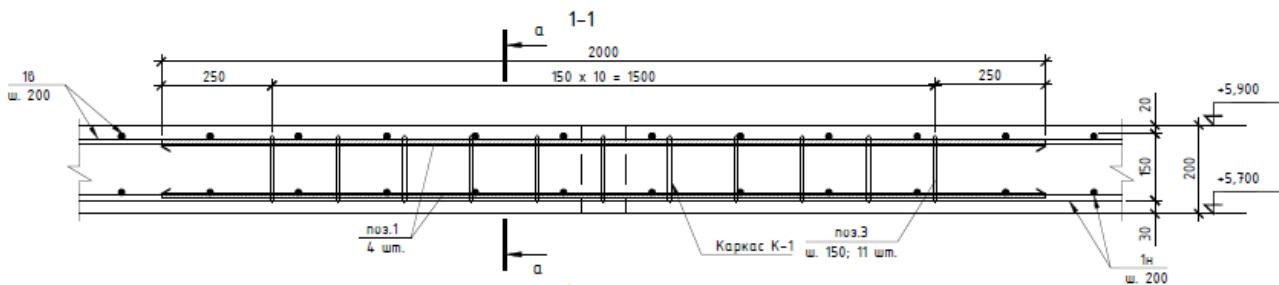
Проект плиты перекрытия (фрагмент проекта дама)
